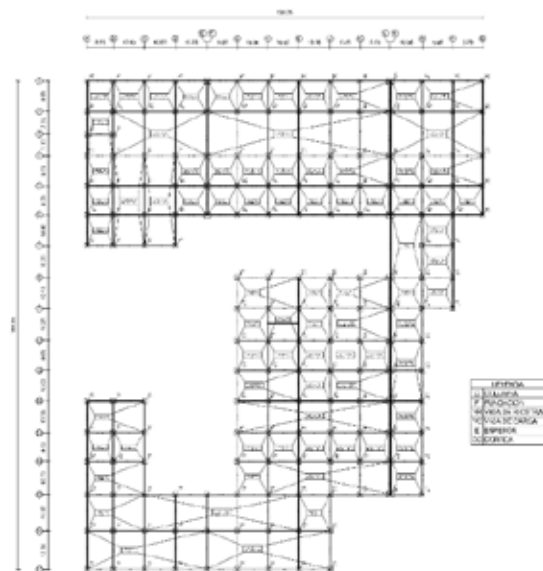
Plano Estructural de Fundaciones del Complejo Industrial y Cultural de Ingeniería Mecánica Automotriz. Fuente: Autor (2021)
